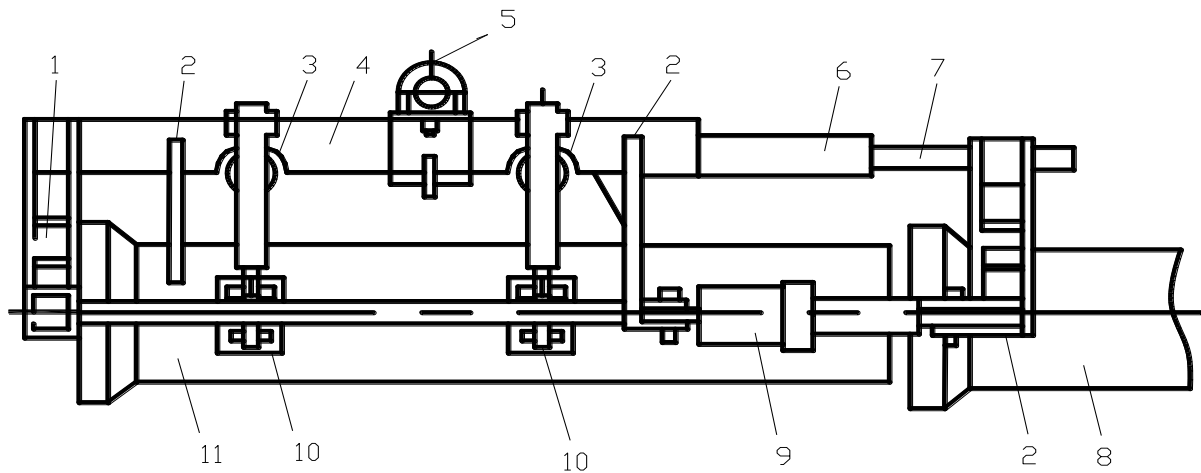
Схема навісного пристрою для монтажу залізобетонних труб на гумових ущільнювальних кільцях:
